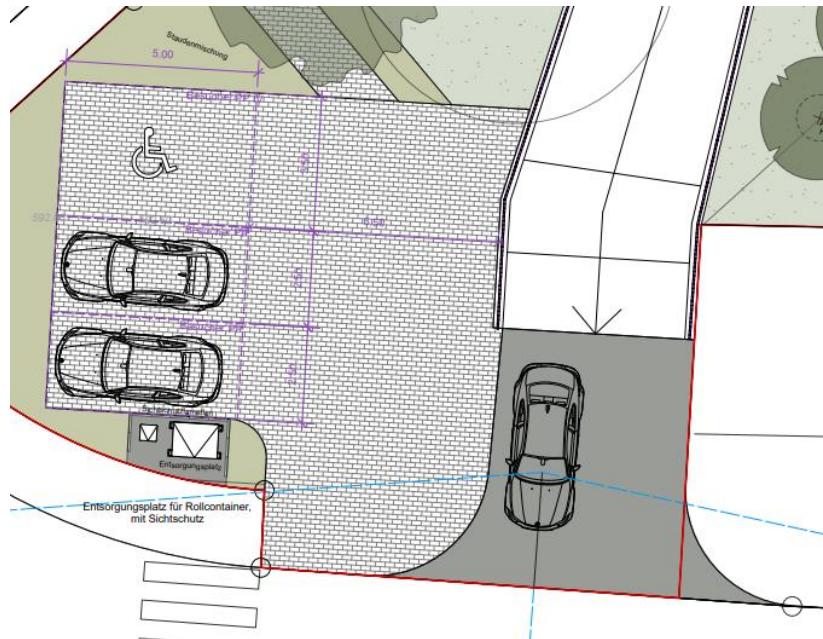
Warteraum für Ausfahrt / Einfahrt Einstellhalle
